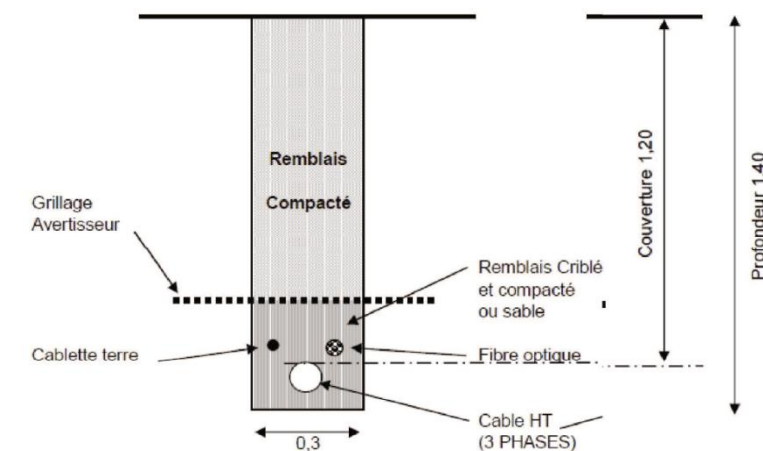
Coupe type d'une tranchée accueillant le câblage (Source : BE Jacquel et Chatillon)
